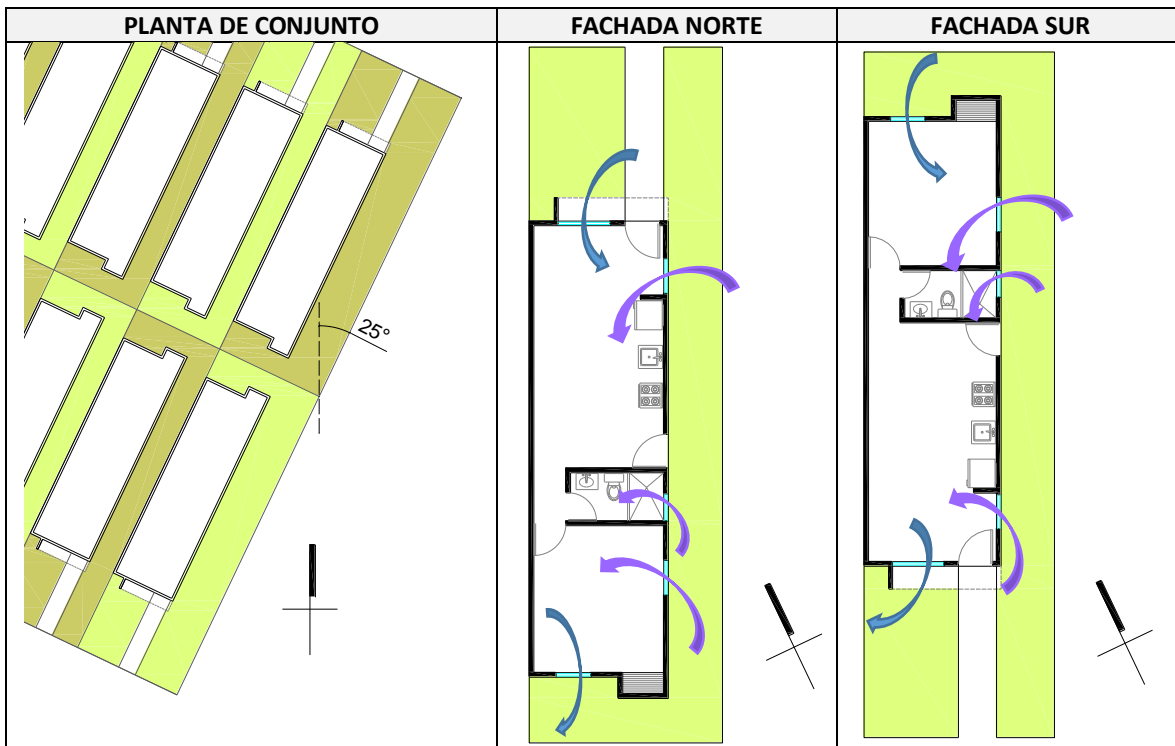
Ventilación de acuerdo a la orientación de la fachada: Microlote T2
